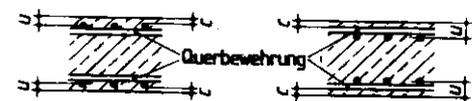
Achsabstände u, u_o und u_s sowie Betondeckung c
